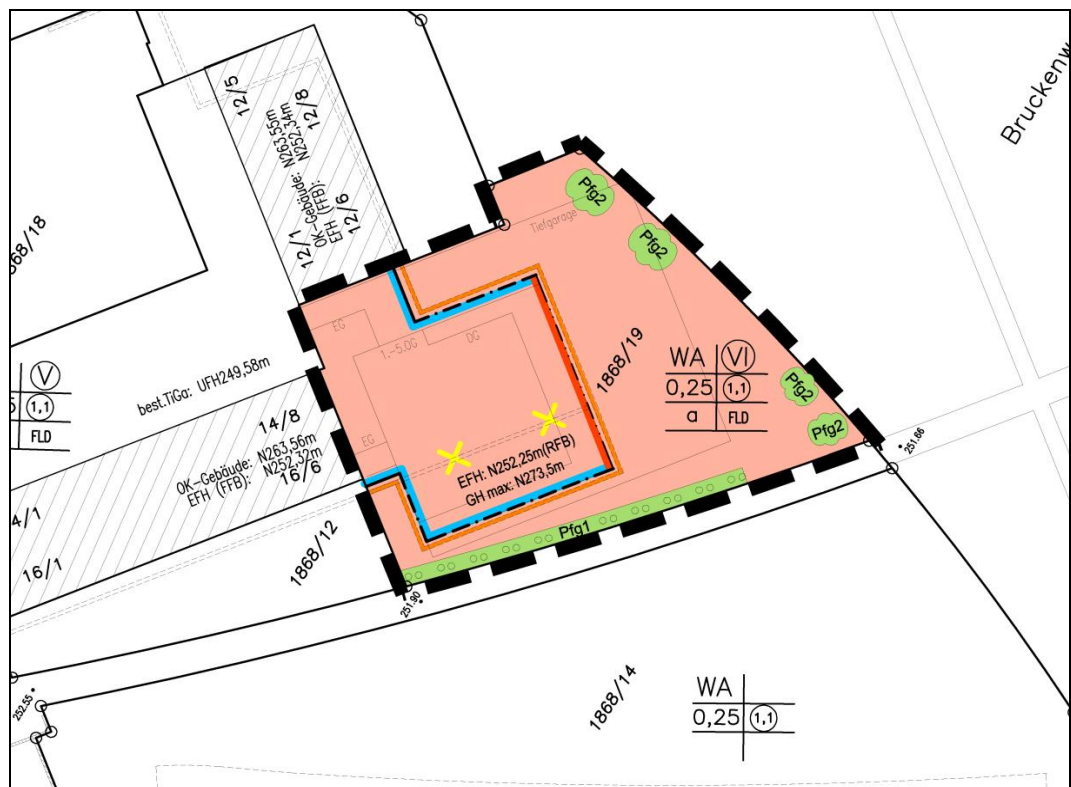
Bebauungsplan „Bruckenwasen, 3. Änderung“ vom 01.10.2018
